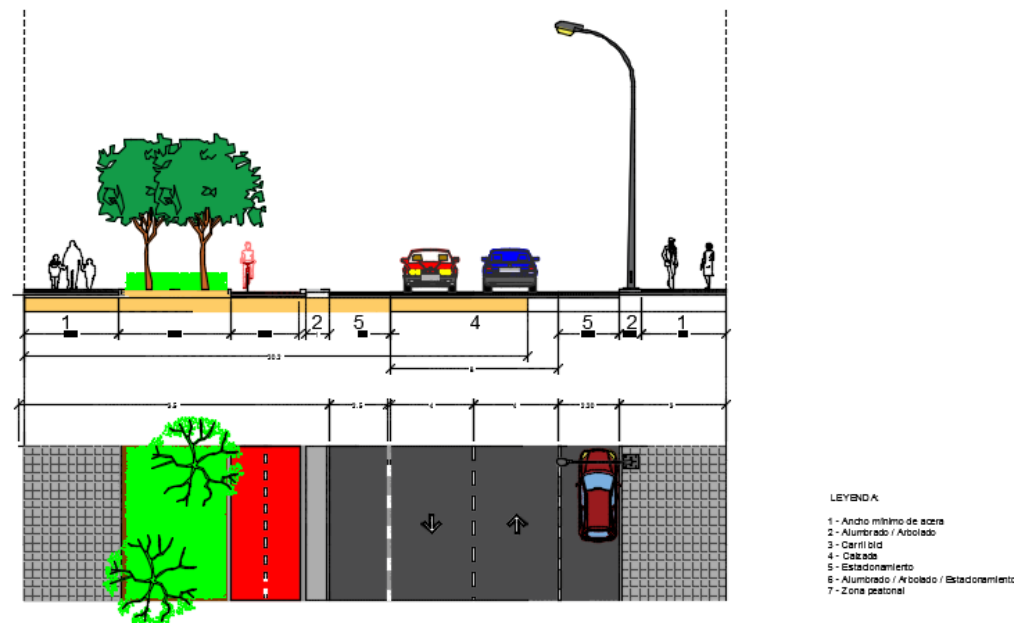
Avenida Camp de Morvedre. Sección tras la actuación.
